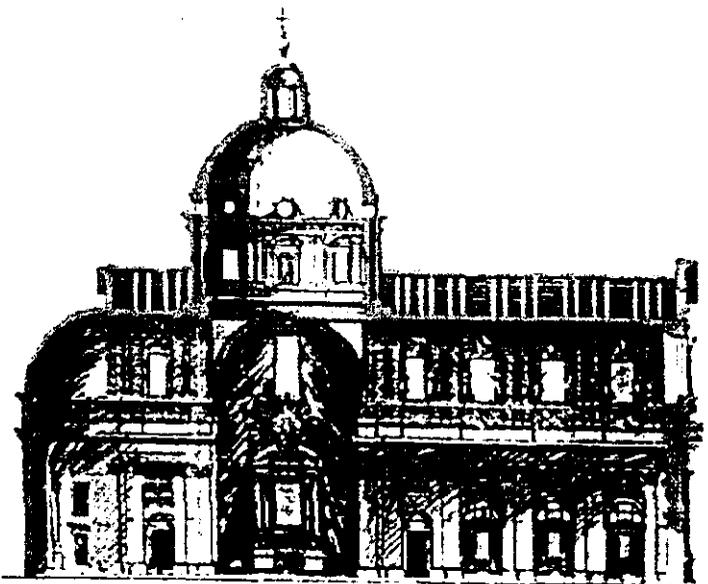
Corte longitudinal de la Iglesia Il Gesú.
